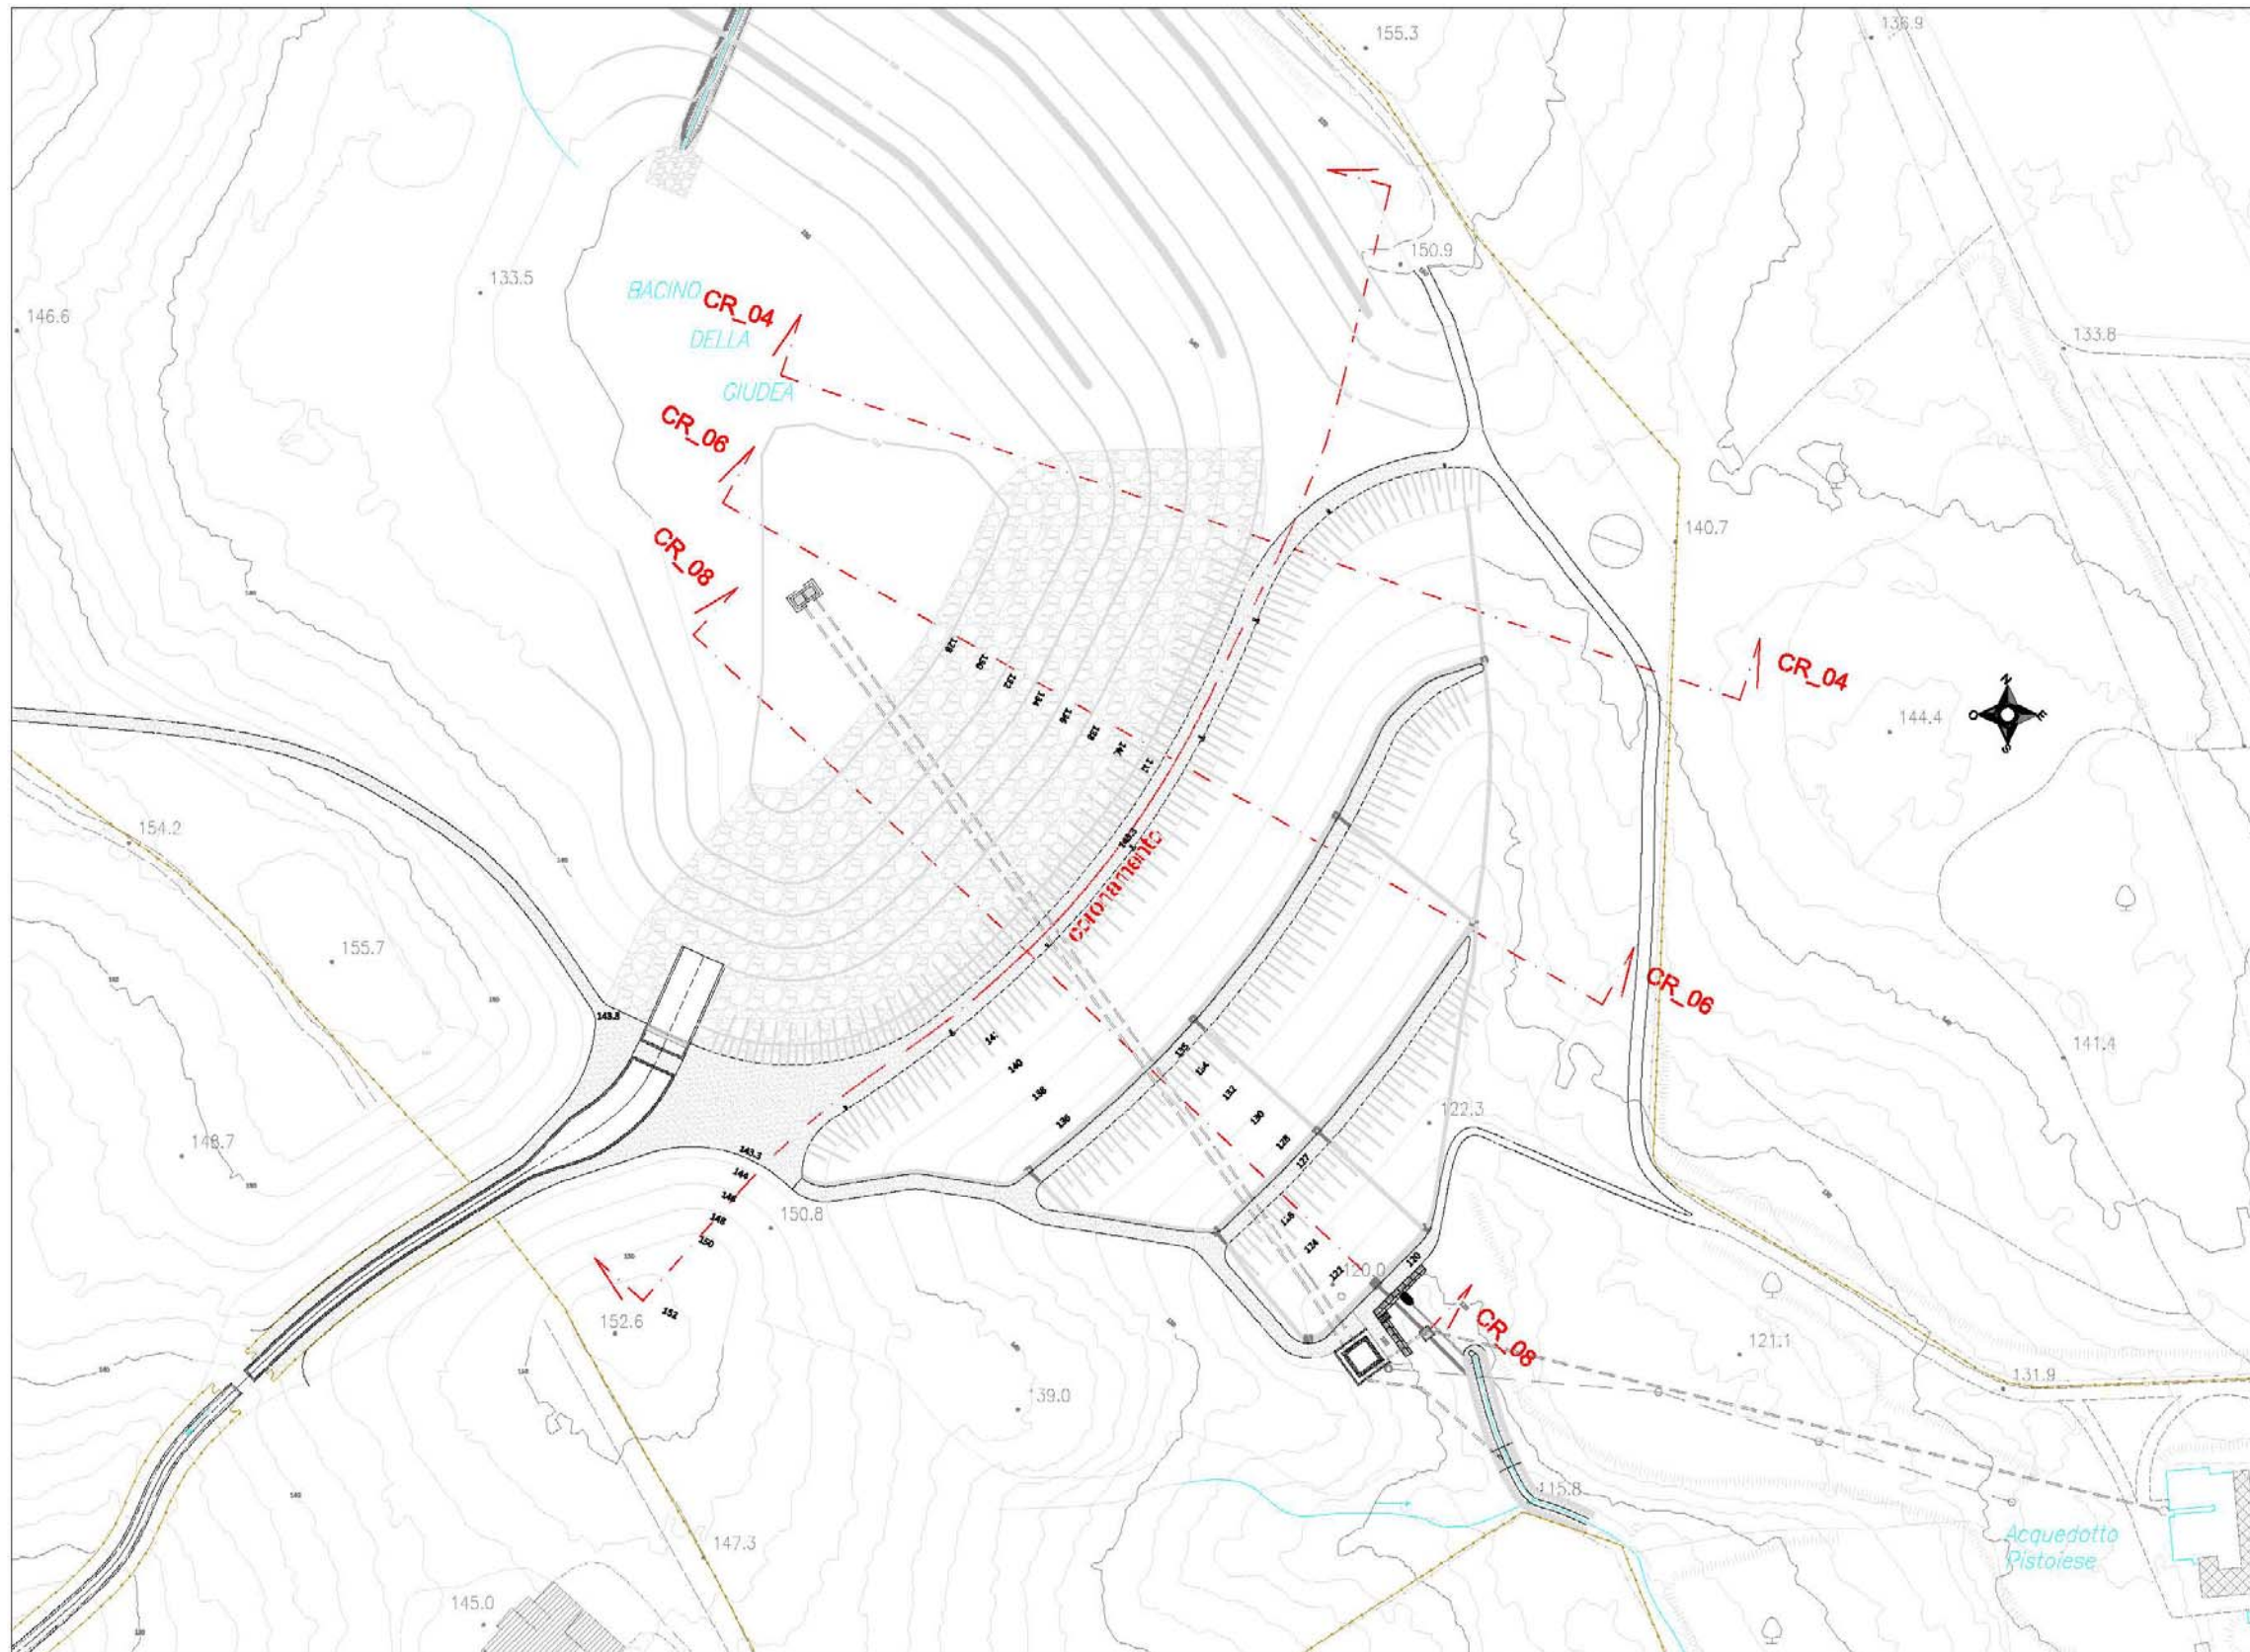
Planimetria sezioni di verifica diga (scala 1:1'500)
